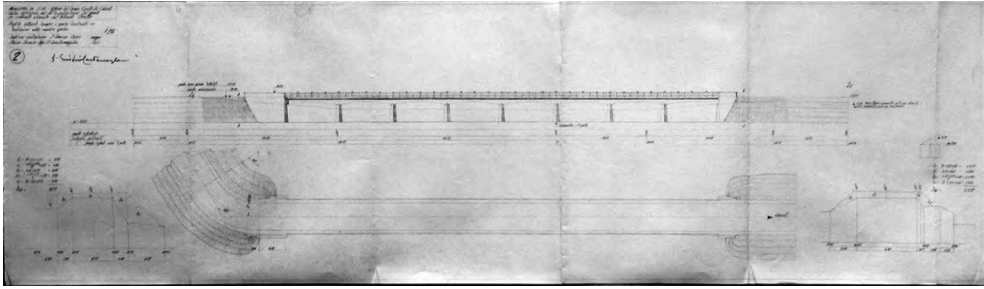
Ing. G. Cantamaglia: ponte sull’Avello, pianta e prospetto, scala 1:200.
